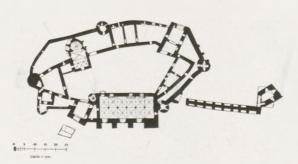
Plan Zamku Vajda Hunyad. 1)
